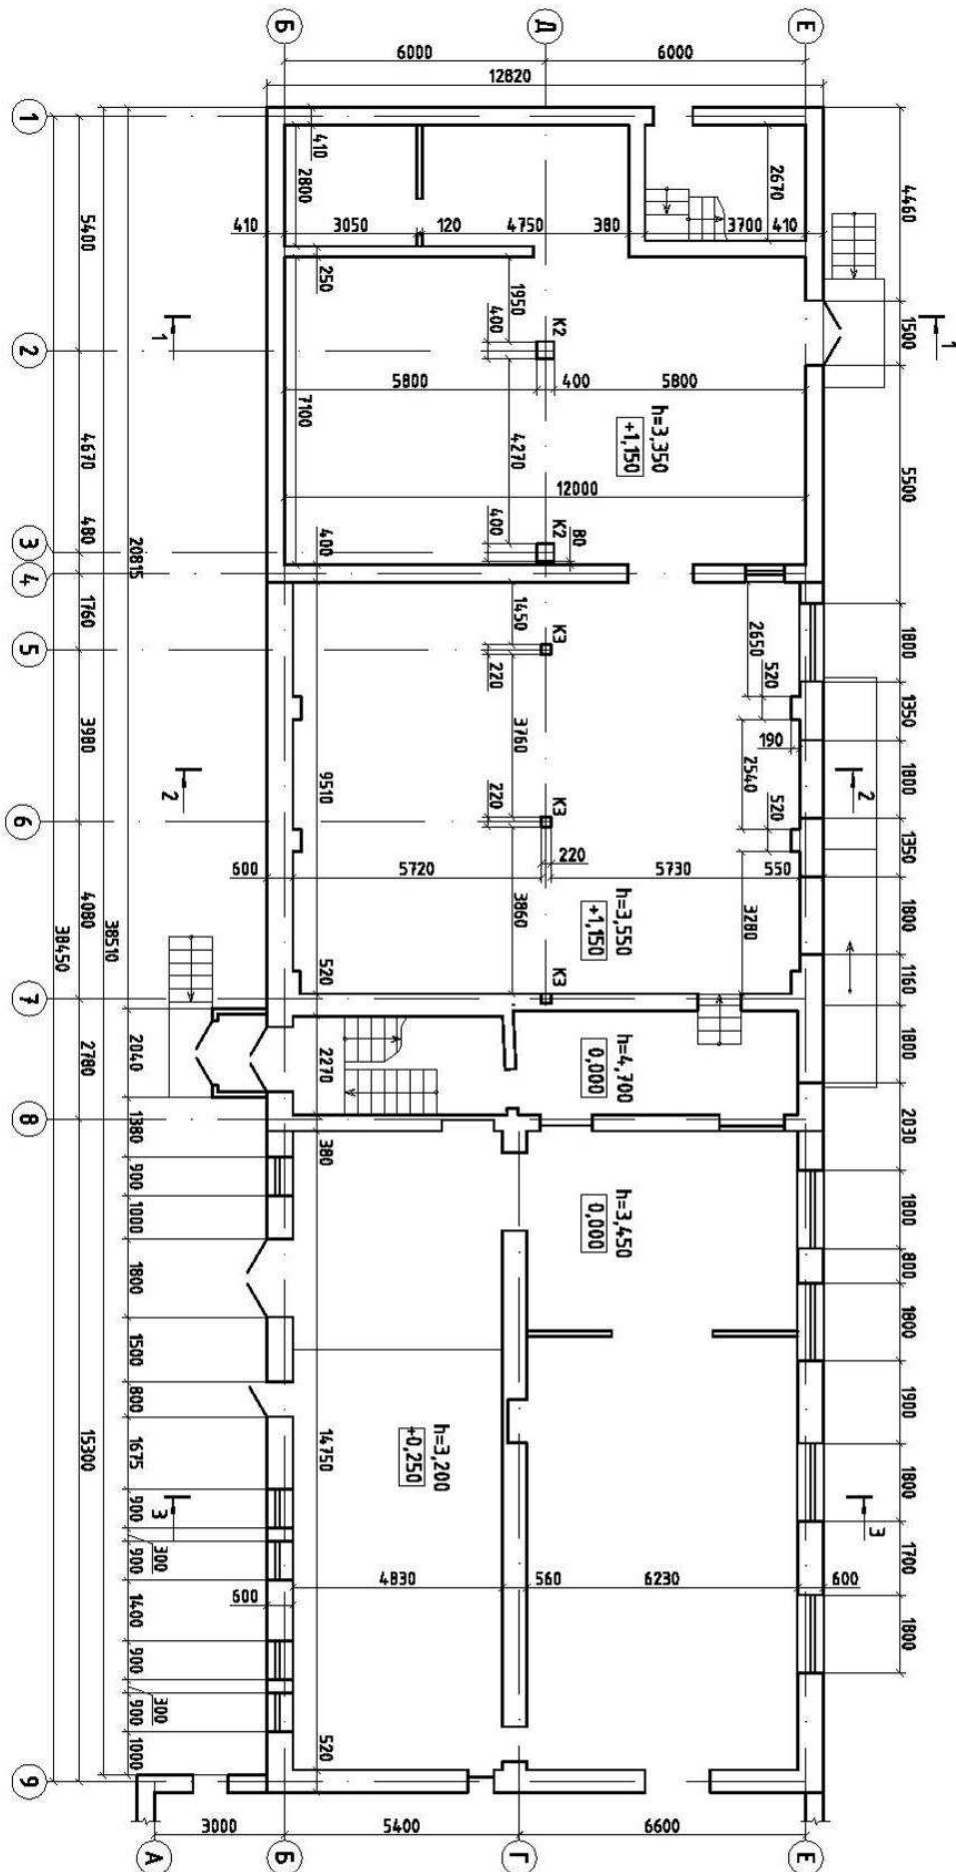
План першого поверху будівлі цеху фасування, складу тари в осях 1-9/Б-Е
